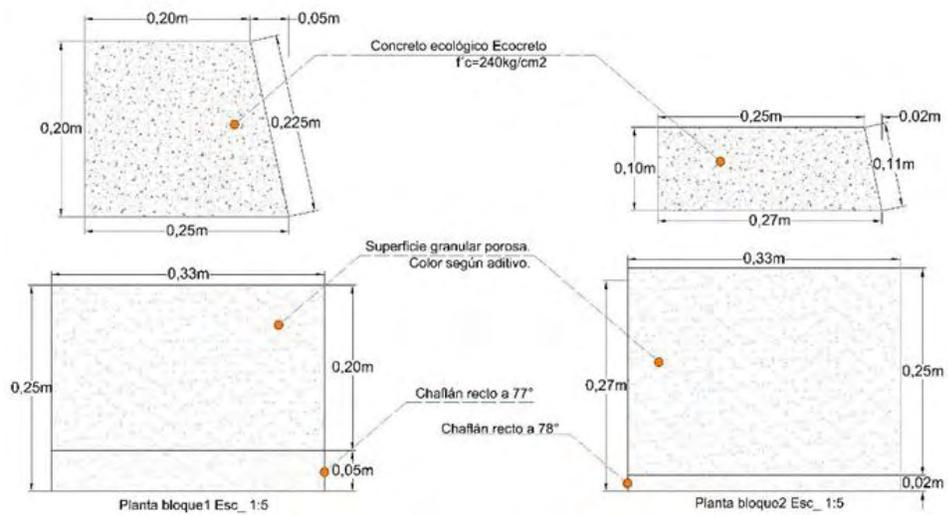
Detalle Bloques en Concreto Ecológico para Senderos.
